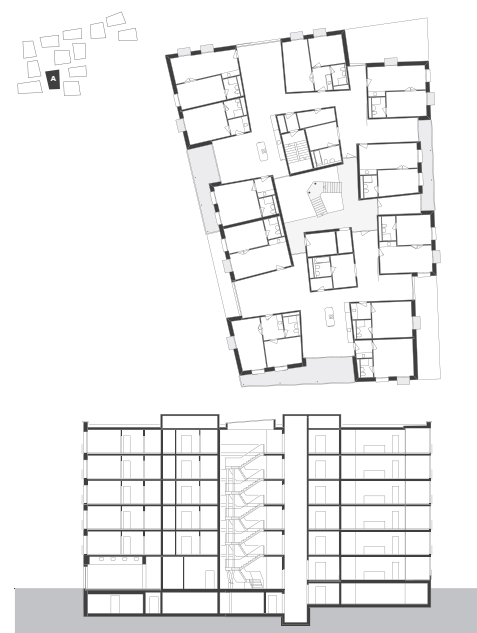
Grundriss und Schnitt des Geb. A von Duplex Architekten
